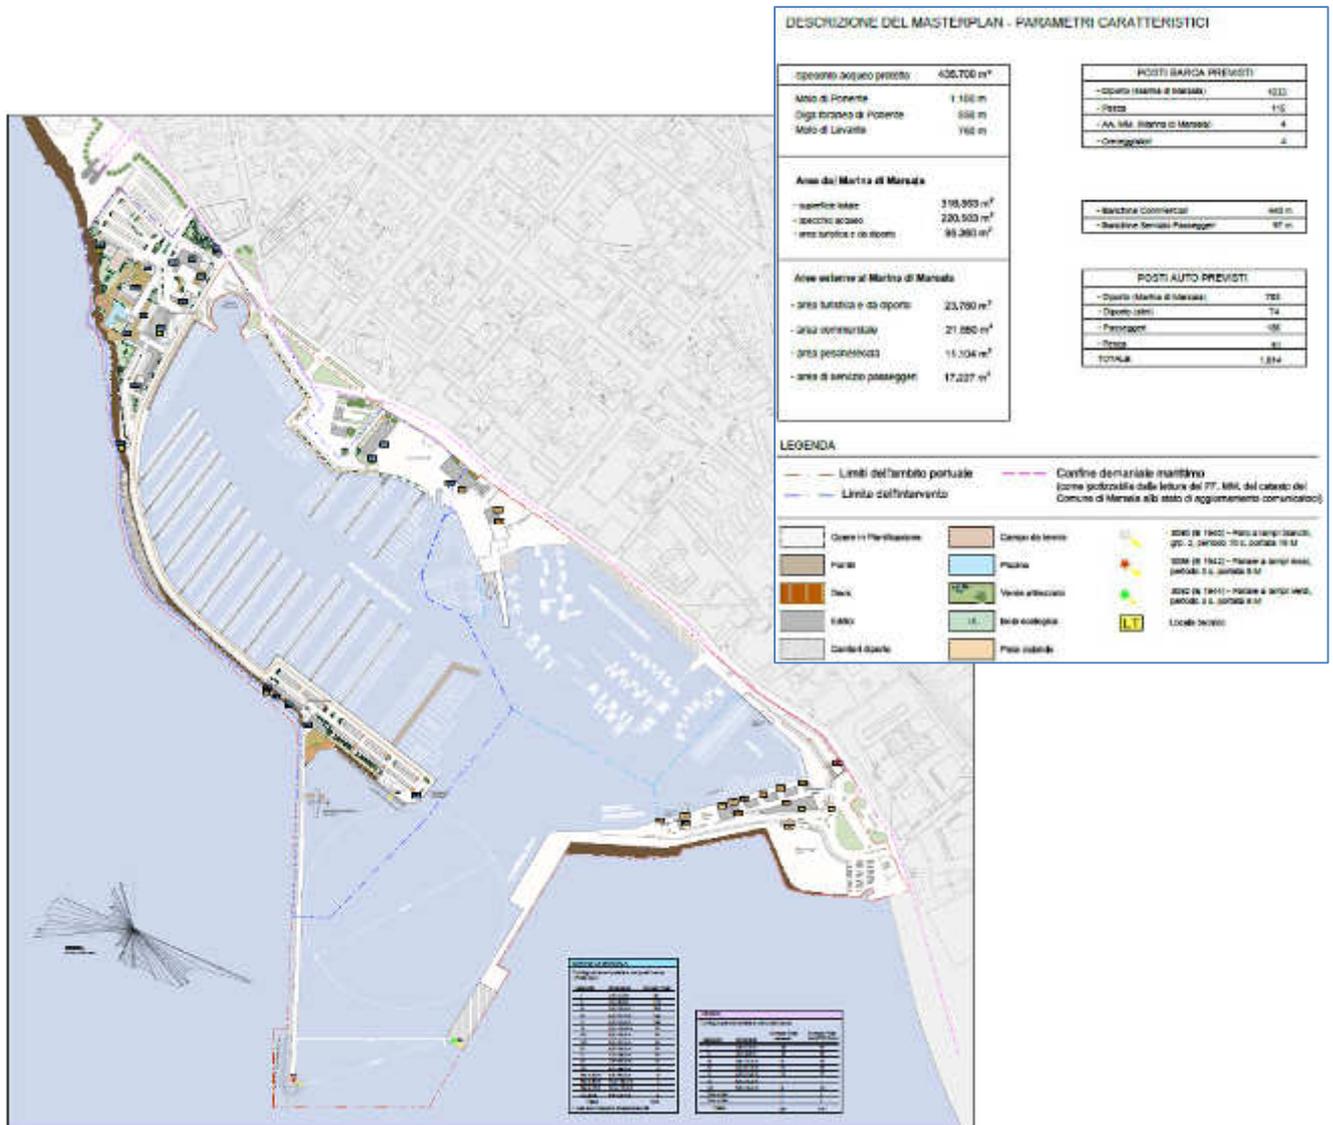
Masterplan di layout del nuovo porto (fonte M.Y.R.)
